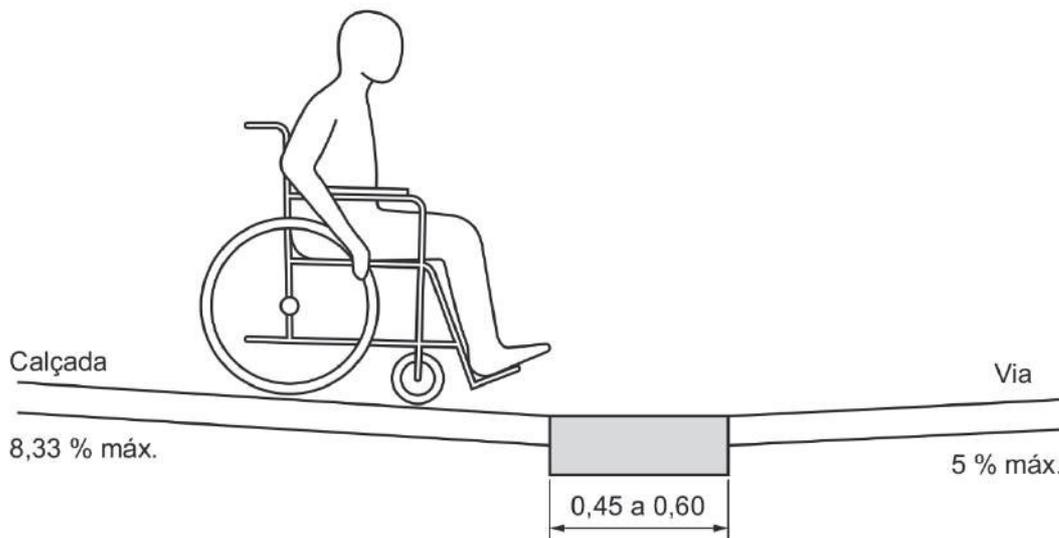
Faixa de acomodação para travessia – Corte (dimensões em metros)
